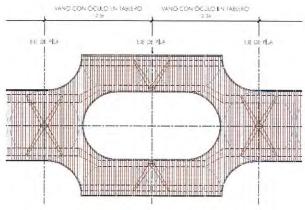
Vista en planta disposición de columnas y bastidor.
